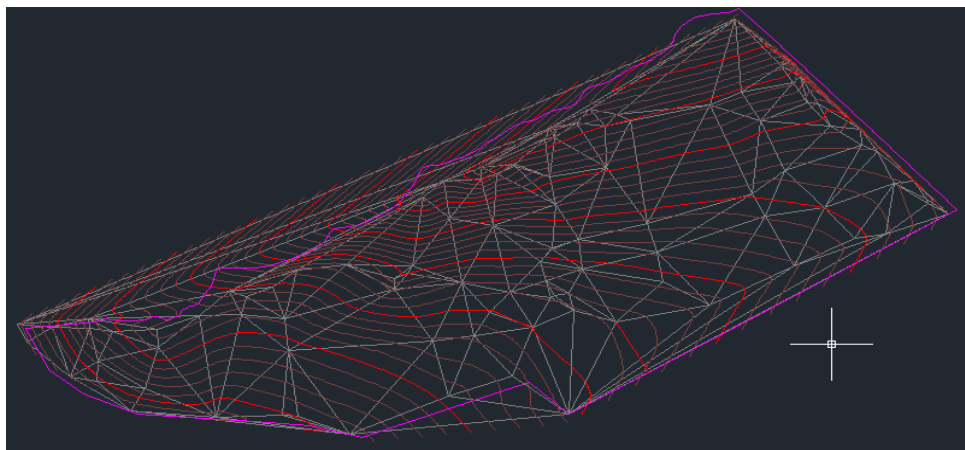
Representação CAD, planta baixa geral da propriedade.
